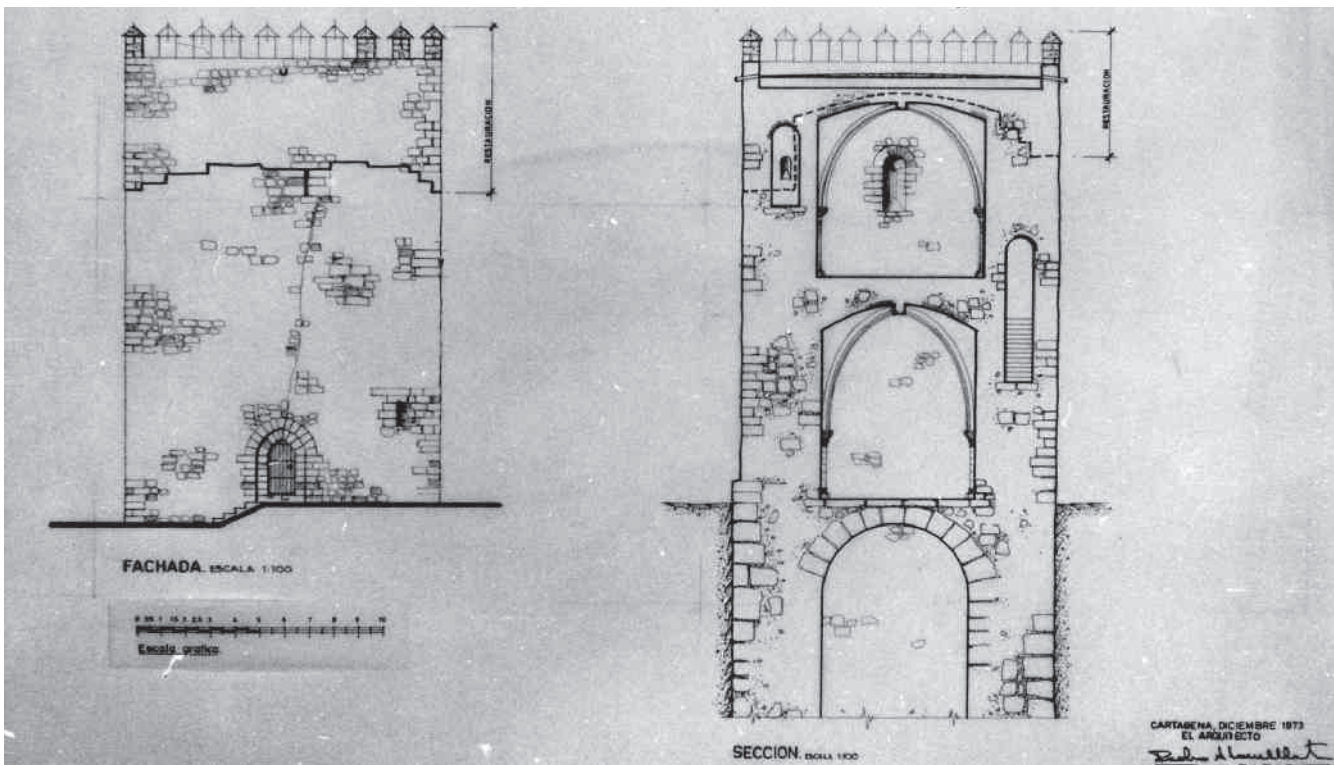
Planos de Pedro San Martín (1973) con su propuesta de restauración.
